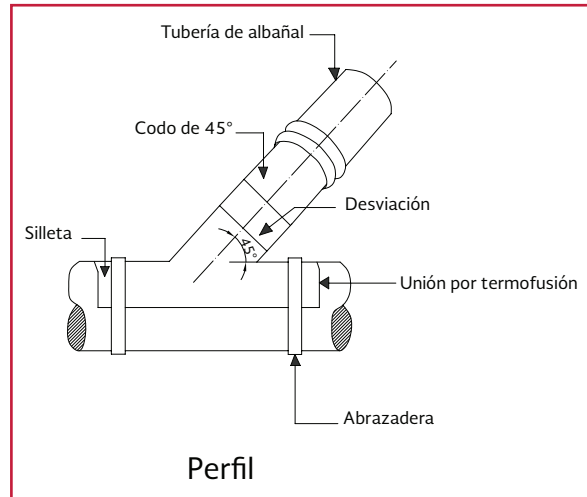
Interconexión de PUR (tubería de plástico y concreto)
